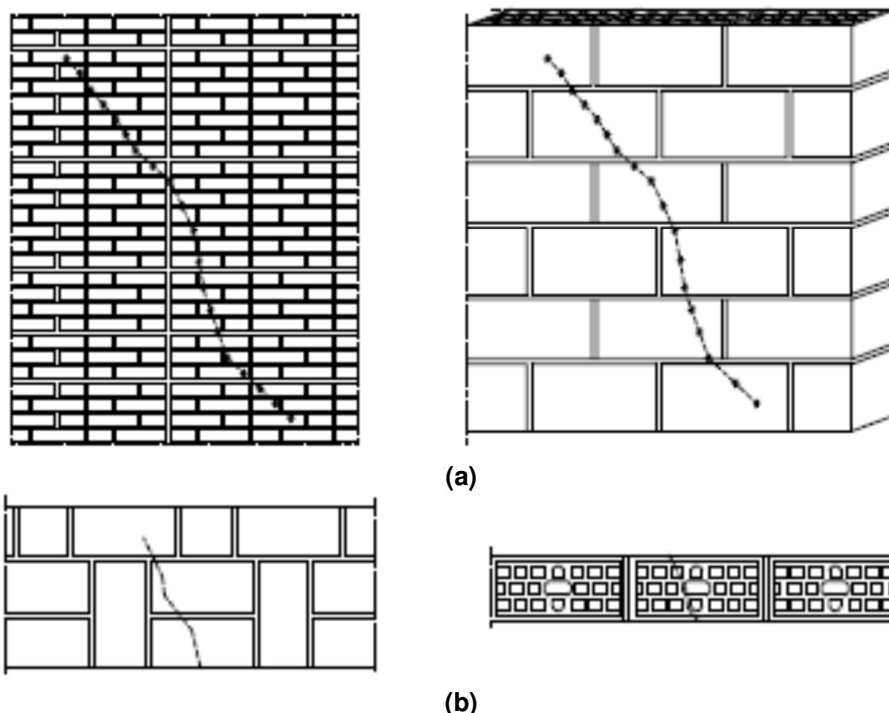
Inyección de la fisura: a) Vista en altura; b) Sección transversal.
